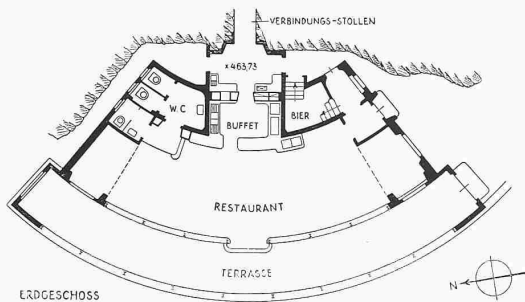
u. 18. Grundrisse 1 : 400. — Die Zimmer im 1. Stock können einzeln oder als Apartment vermietet werden
